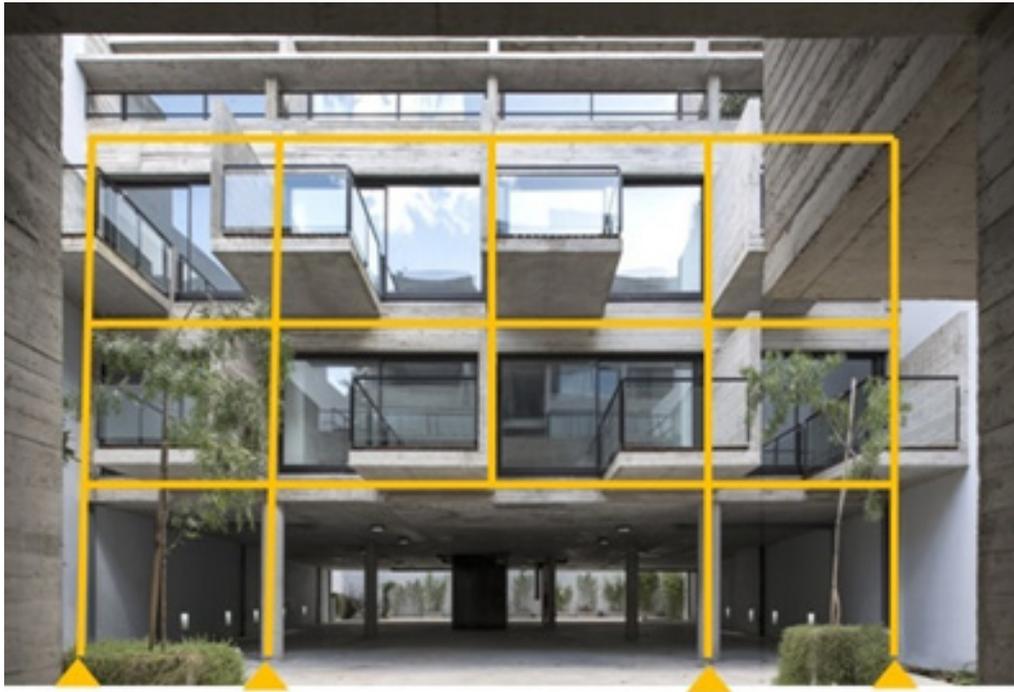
Esquema de transición sobre planta baja. Fuente: Elaboración propia
